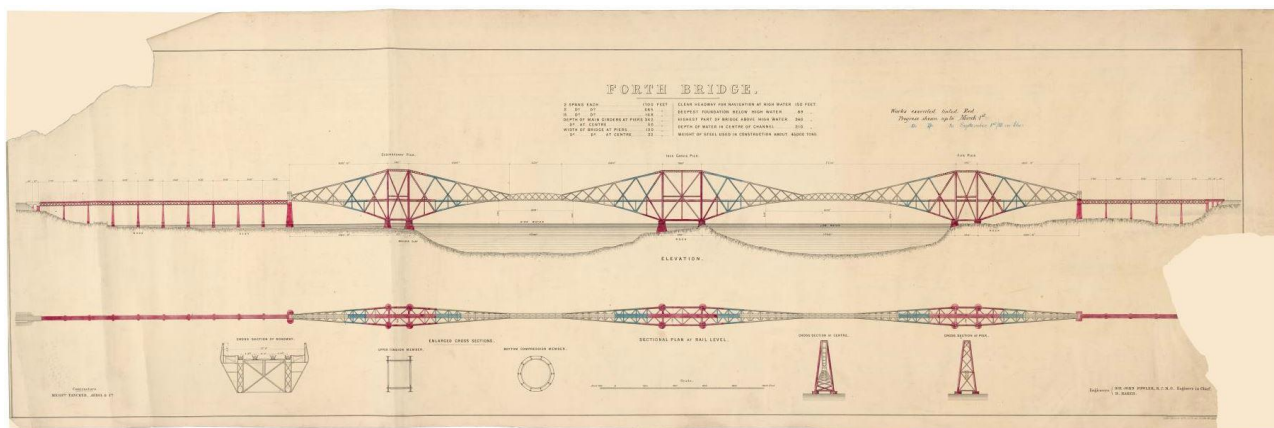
Planimetria e prospetto del Forth Bridge, Messers Tancrad Arrol & Co., 1888. (Network Rail Archive, NRCA 110040).
